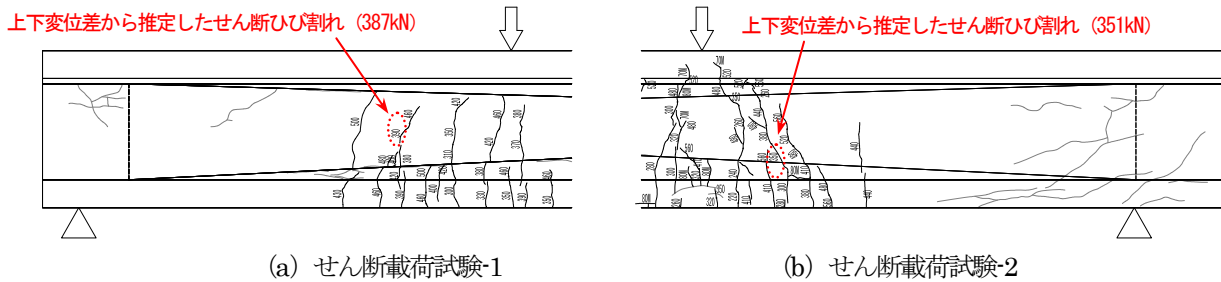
ひび割れ図（せん断载荷試験）
